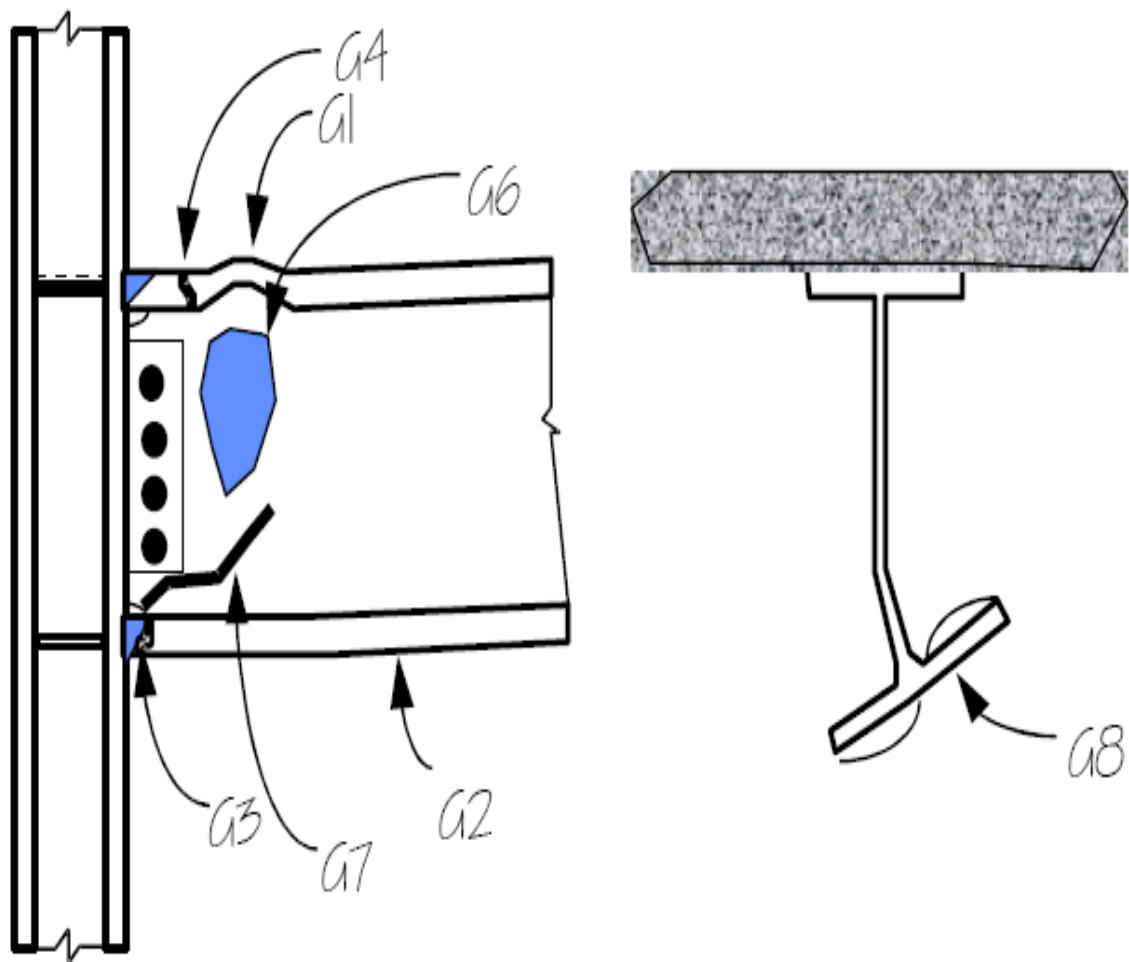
18 Fallas típicas en vigas (SAC Joint Venture, 2000).
